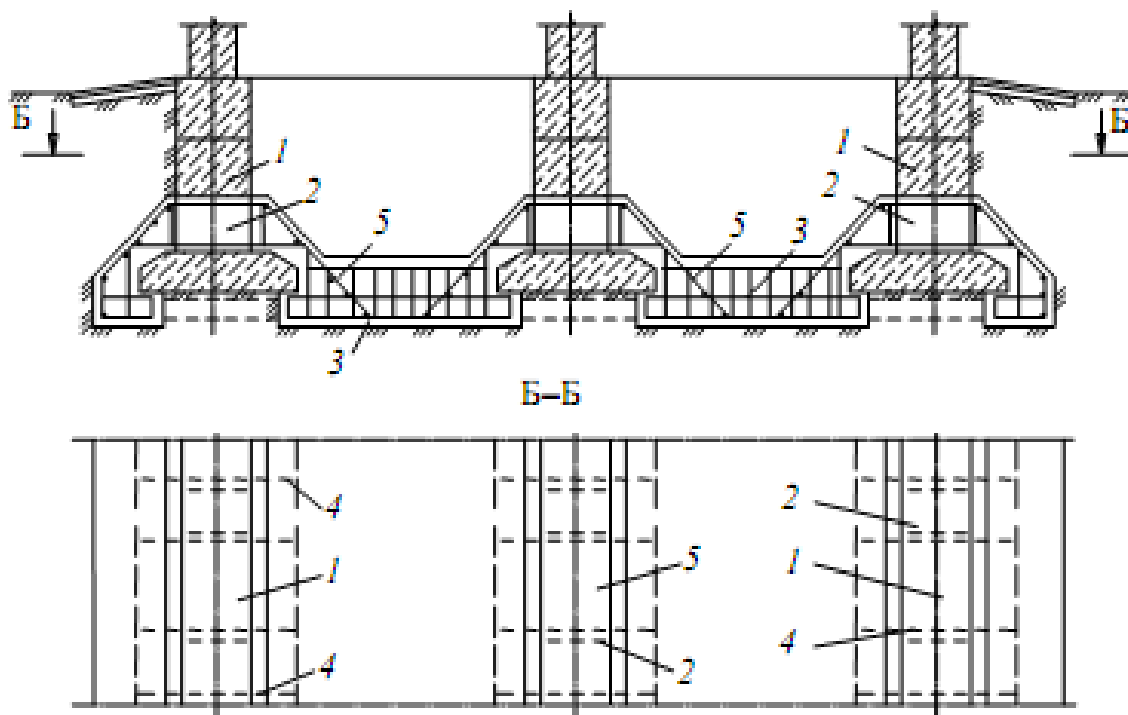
Перебудова стрічкових фундаментів у плитні:
